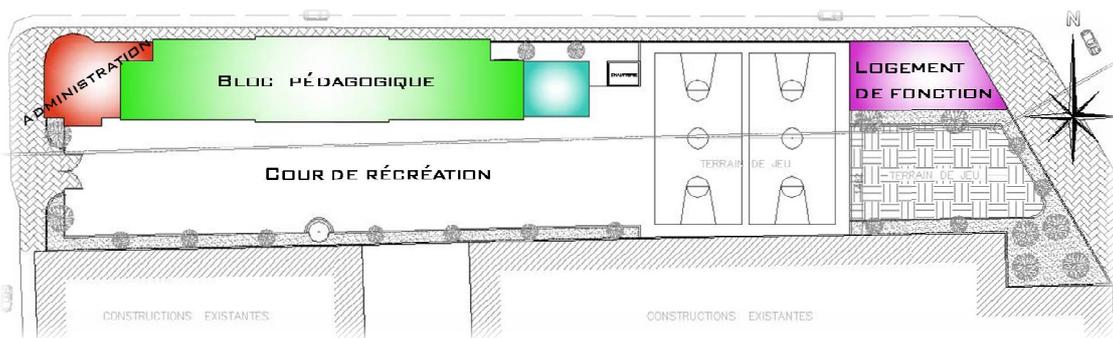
Plan du rez-de-chaussée de E3 -B1- RH
